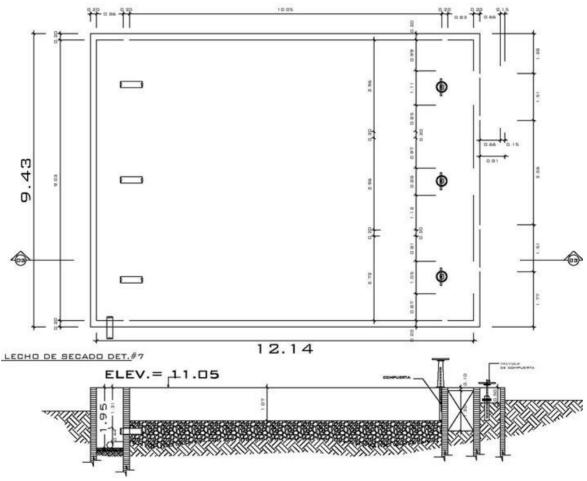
Planta y Sección Lecho de Secado de Lodos de Los Americanos Fuente: (Báez, 2014)
